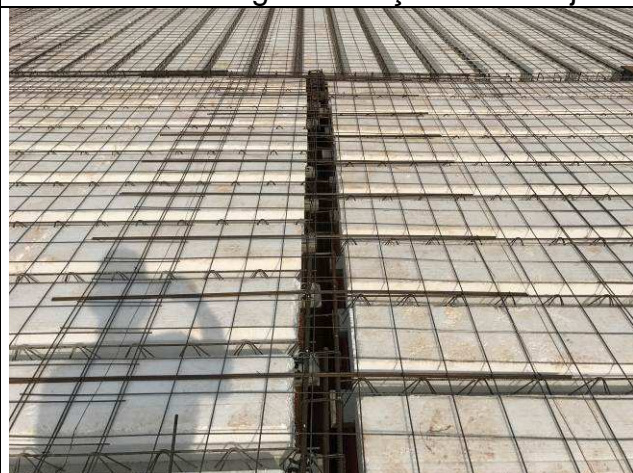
C: Laje e vigas de cobertura do prédio principal - eixos 1-5 e D-F.
